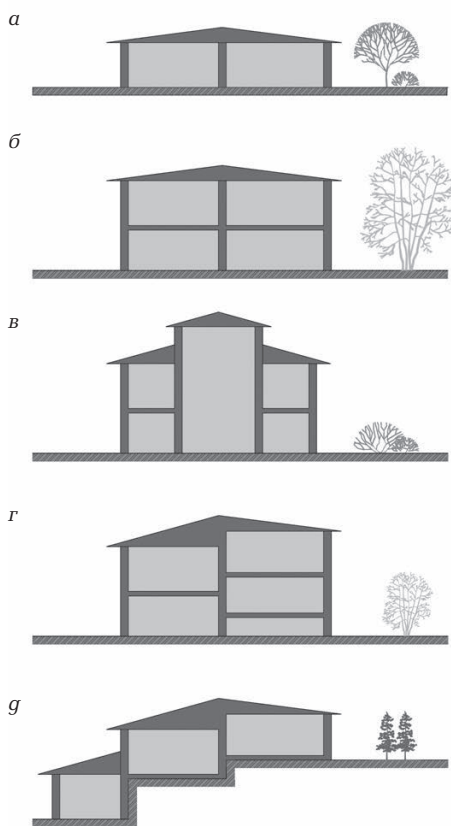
Схемы решения индивидуального жилого дома из бруса при разграничении зон:
